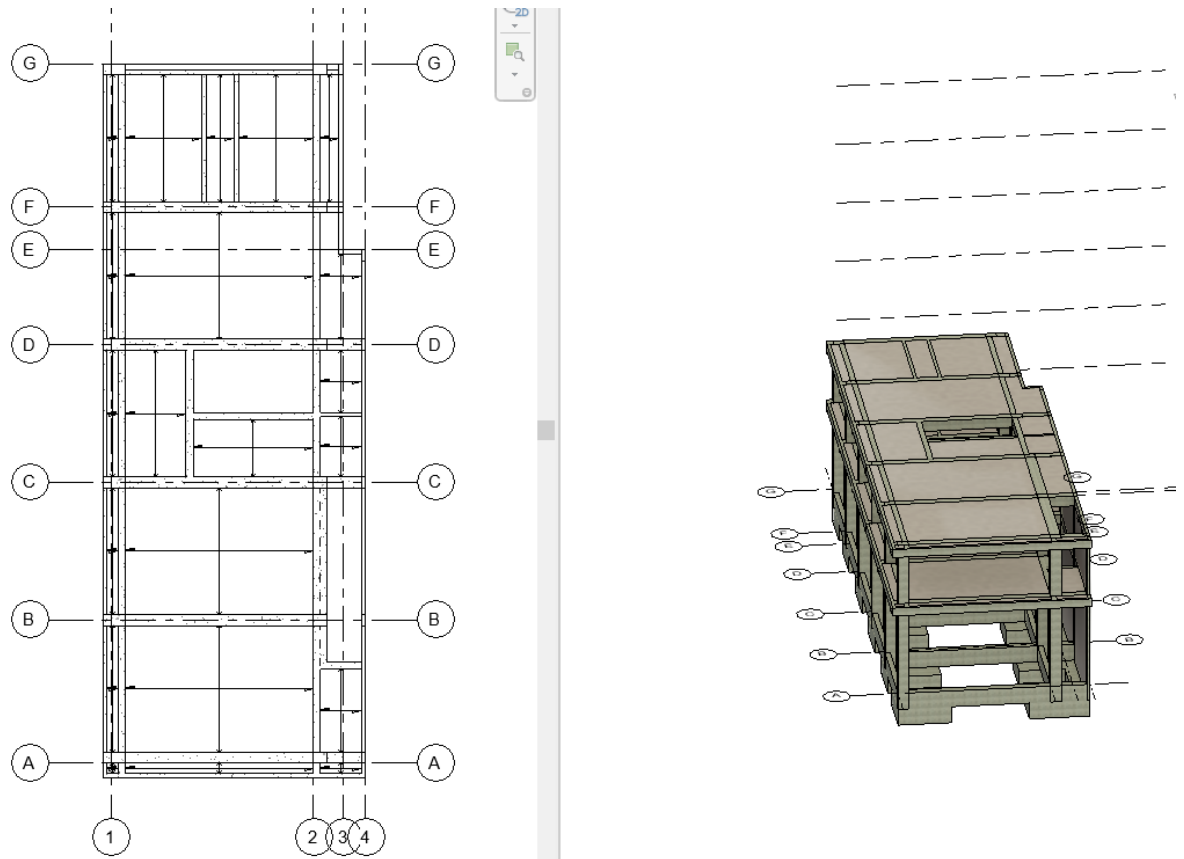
Lado izquierdo Vista de la planta del 2do Nivel y al lado derecho la vista en 3D (Fuente: Elaboración Propia).
